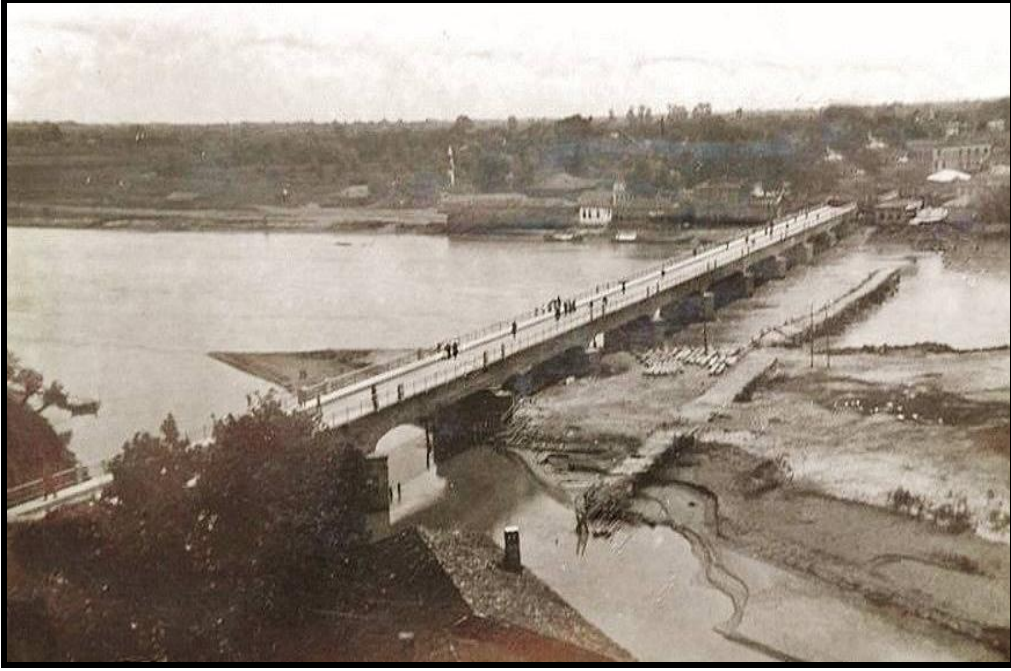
Tahta köprü terk edilmiş, beton köprü kullanıma açılmış, 1930'lu yılların başları (Anonim).
